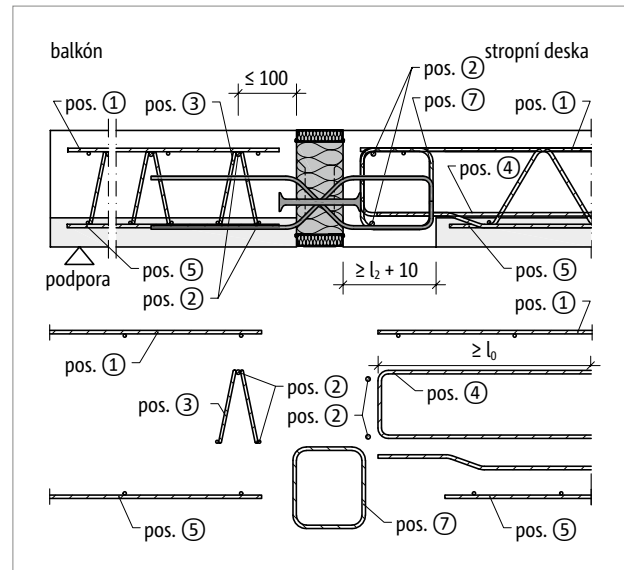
Schöck Isokorb® T typ QPN-VV1 až VV8: Napojovací stavební výztuž
